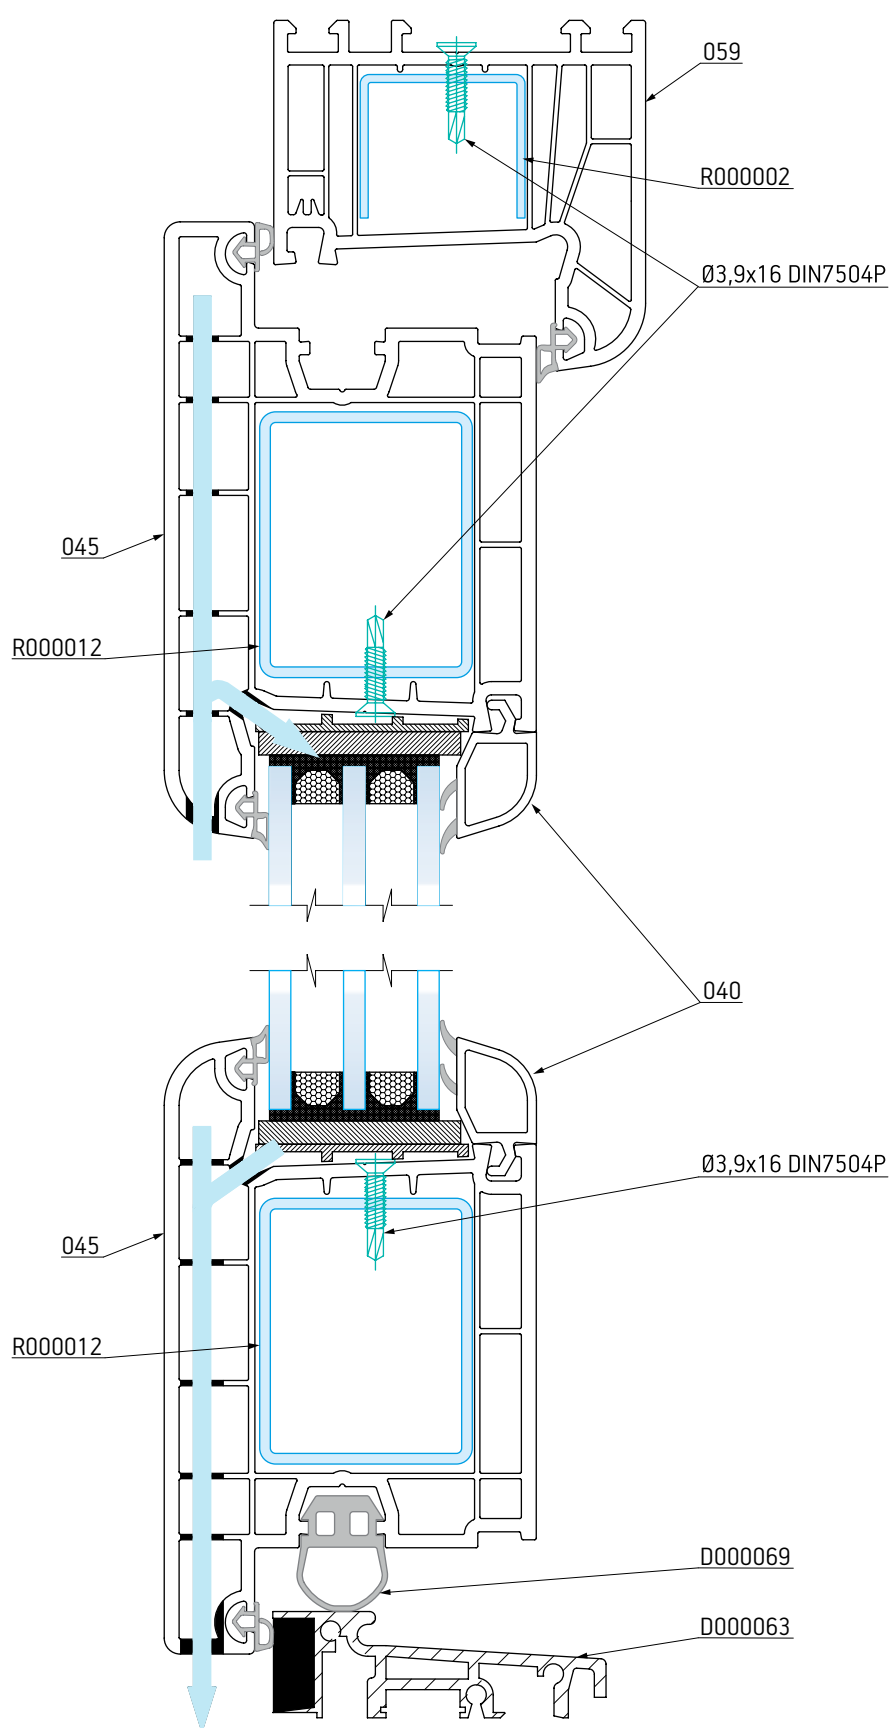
Типовые схемы вентиляции предкамеры для цветных профилей
